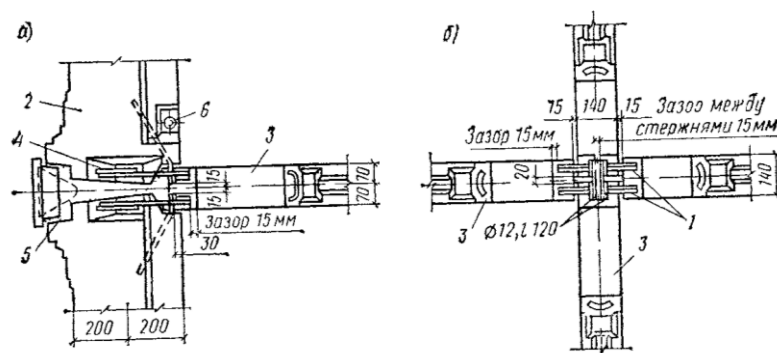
Соединения панелей стен зданий высотой до пяти этажей
